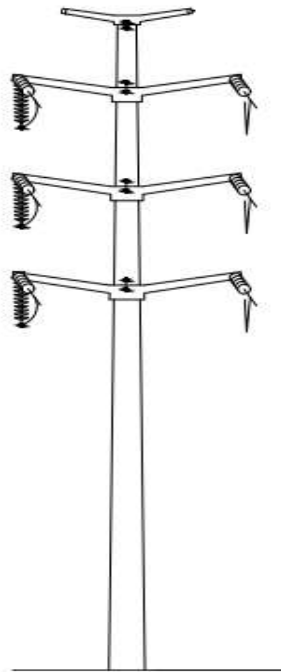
Estruturas monotubulares do tipo poste em concreto armado, modelo ADCE.
